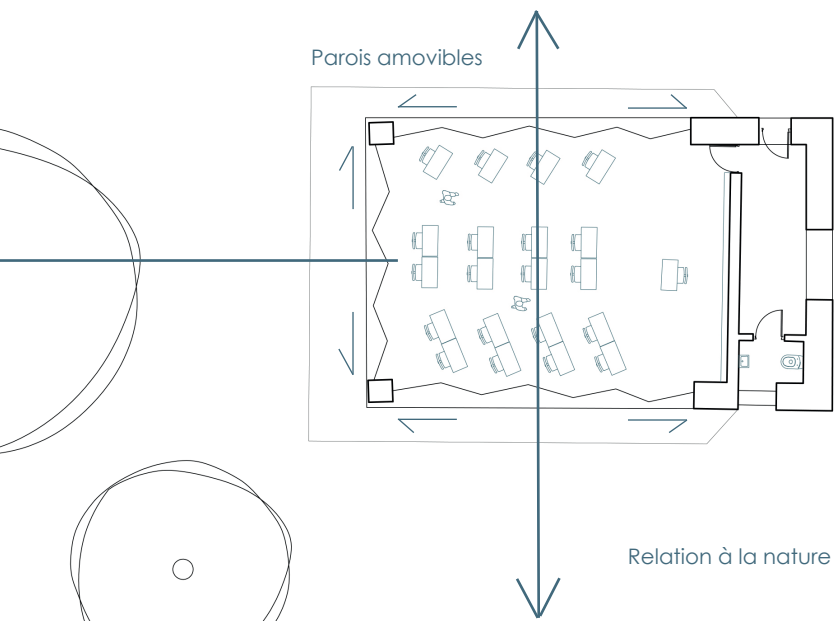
Plan d'un pavillon-classe de l'école de plein air, Suresnes
